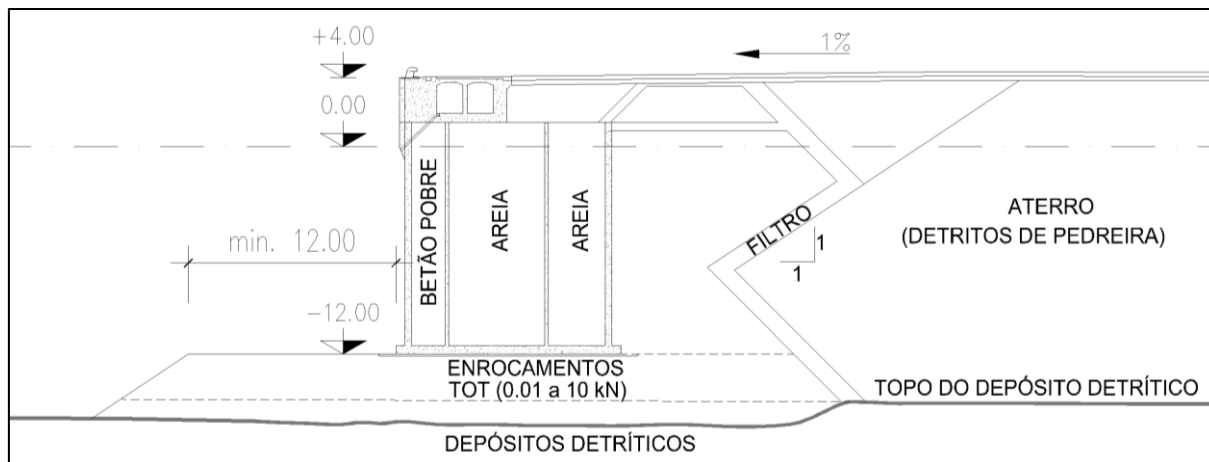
Perfil Transversal tipo do cais à -12 m (ZH) construído em 1985
